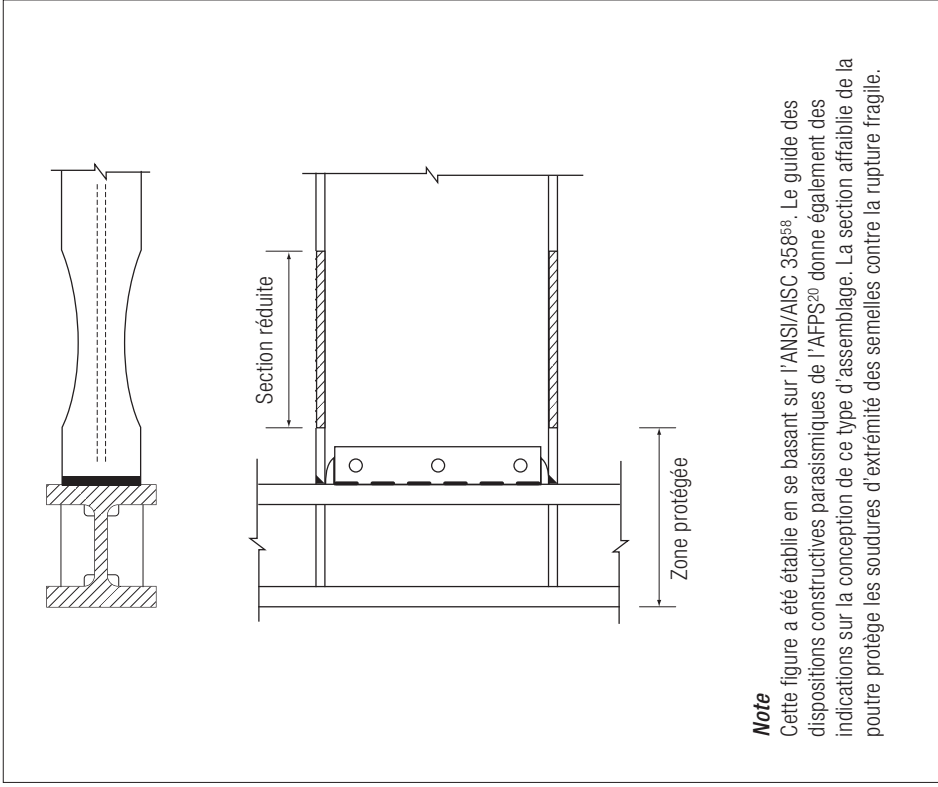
Assemblage d'une poutre dont la section est affaiblie
